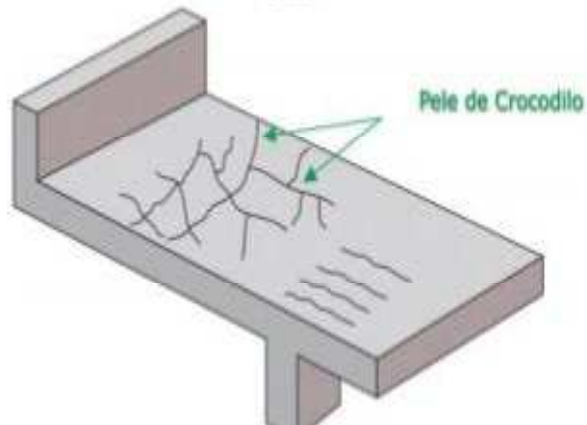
Configurações das fissuras geradas pelo assentamento Plástico.
